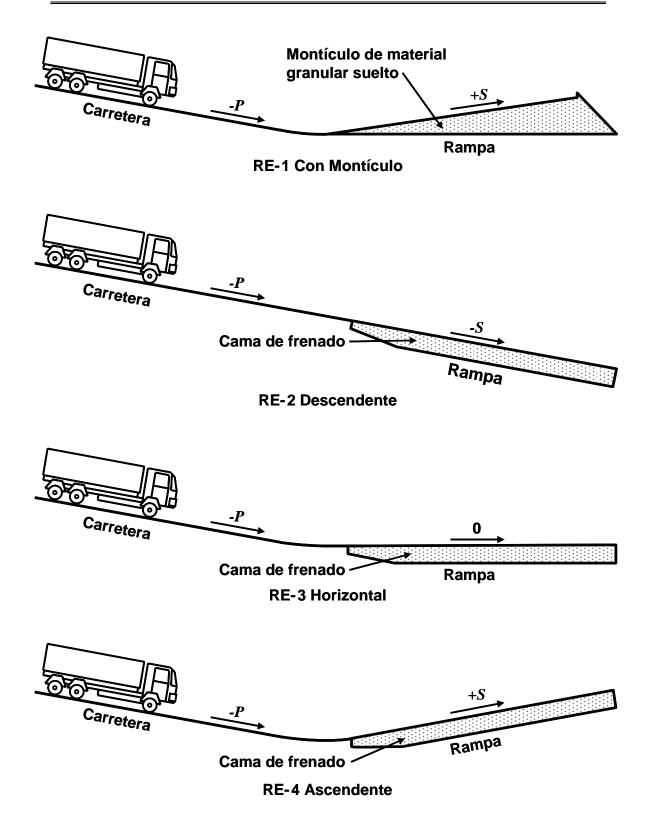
Tipos de rampas de emergencia para frenado (RE)
